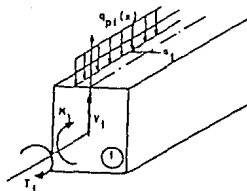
Sección de la viga  $n_1$ . (Ref 3).
